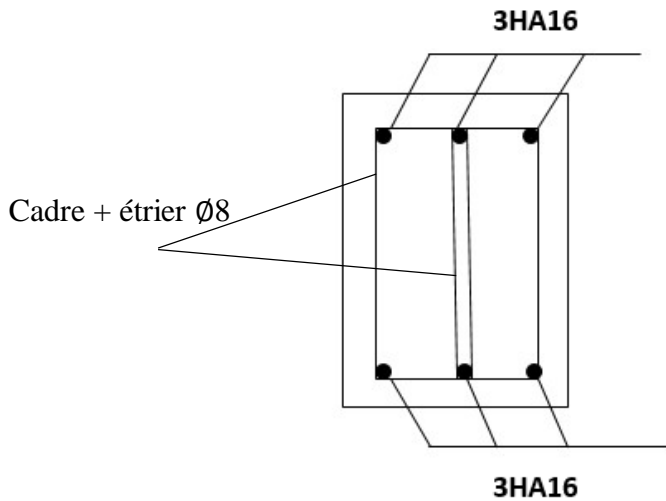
Figure IX.4 Schéma de ferrailage des poutres en travée.
